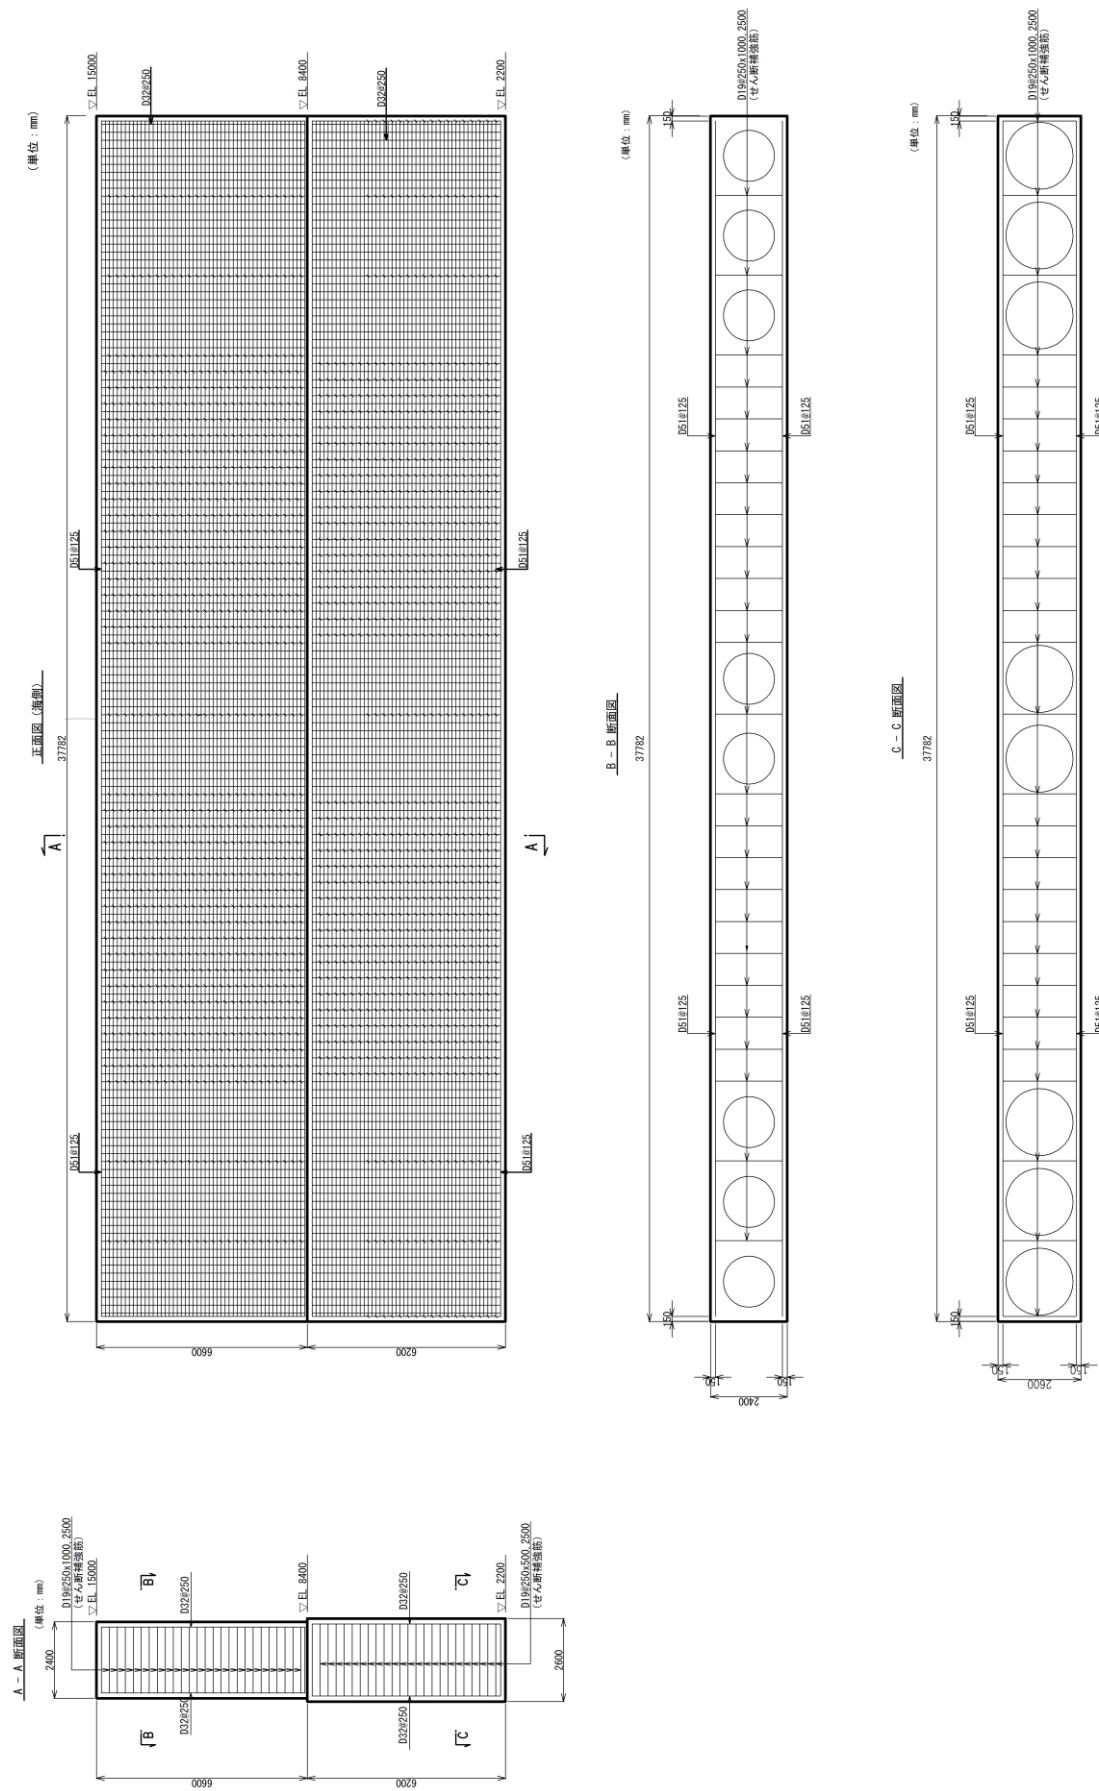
防波壁 (多重鋼管杭式擁壁) の被覆コンクリート壁の概略配筋図 (④-④断面)
